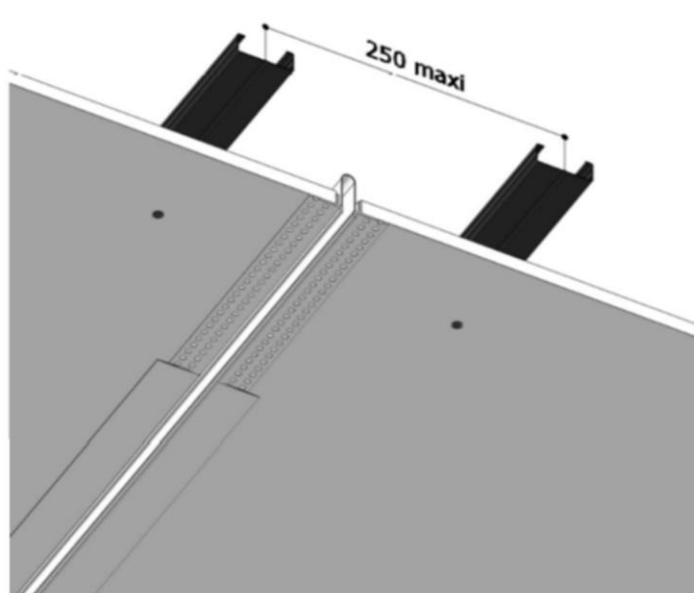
Plafond intérieur HydroProof® – Joint de fractionnement
